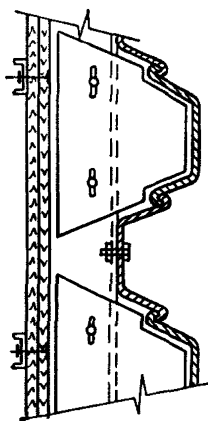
Схема стыкования дна опалубки с металлическим шпунтом
